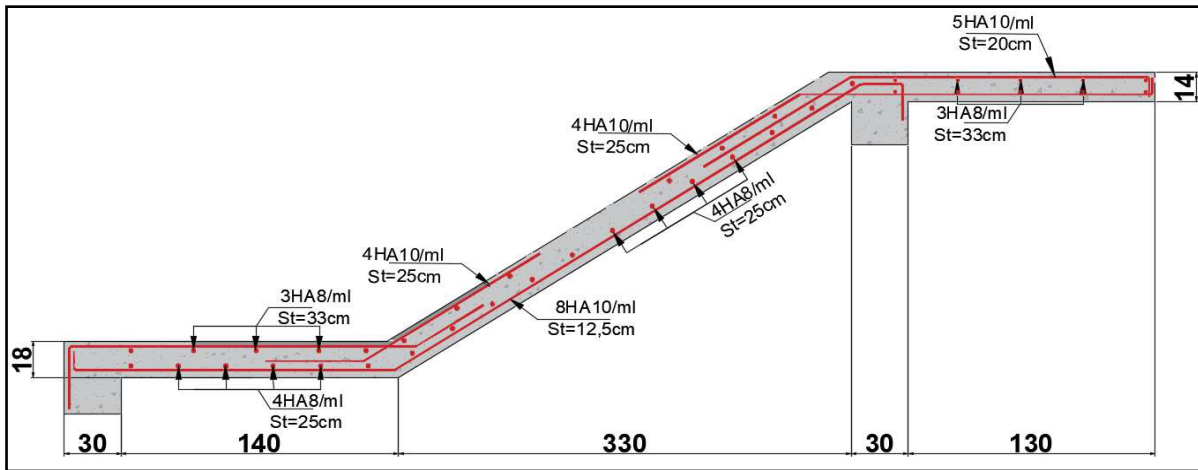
Schéma de ferrailage de l'escalier A-B et B-C.
